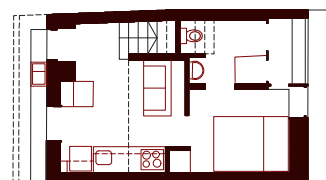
Planta baixa variação tipo A Ilha da Bela Vista - LAHBSocial
